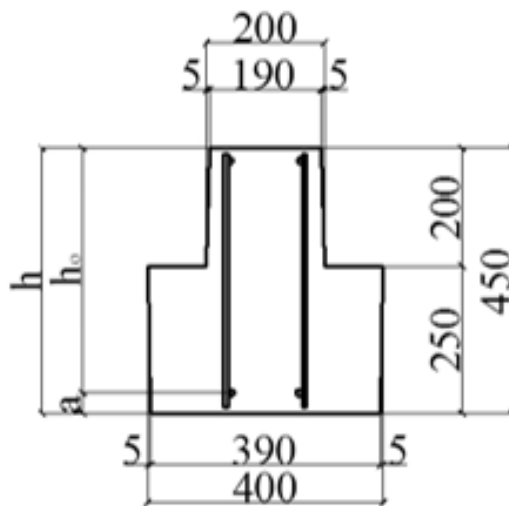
Расчетное сечение ригеля в месте обрыва арматуры
